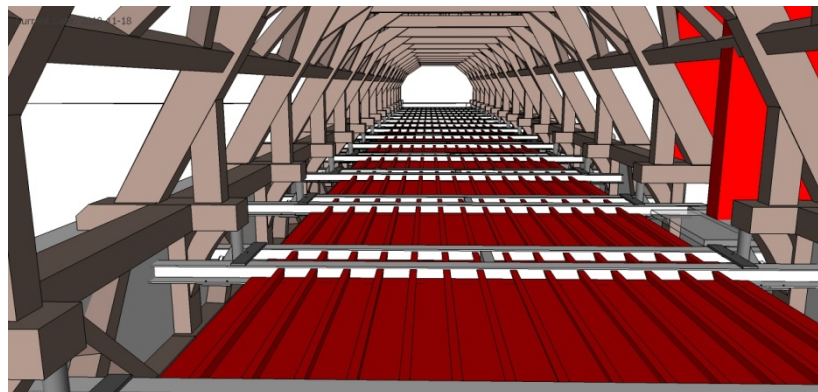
Fixation des tôles de coffrage de la dalle entre les poutres IPE.
